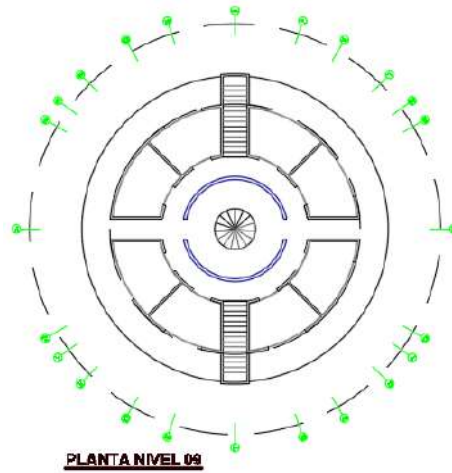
Planta del noveno nivel. (Fuente Autor)
